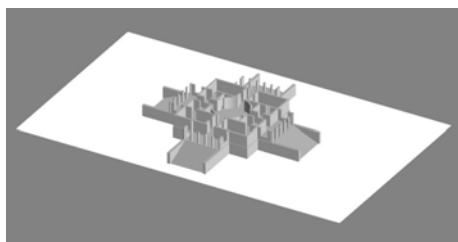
Axonométrica Villa Capra. Fonte:autor
